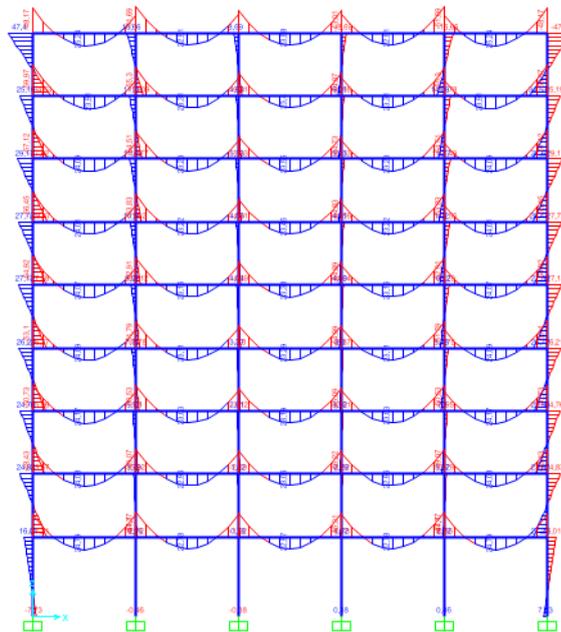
Pembebanan Beban Hidup pada Balok Tengah Arah X
